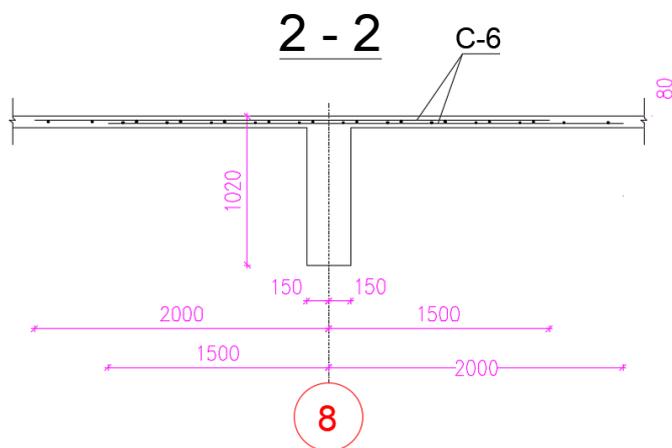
Армирование опорных зон второстепенной балки сварными сетками (арматура балок условно не показана)
